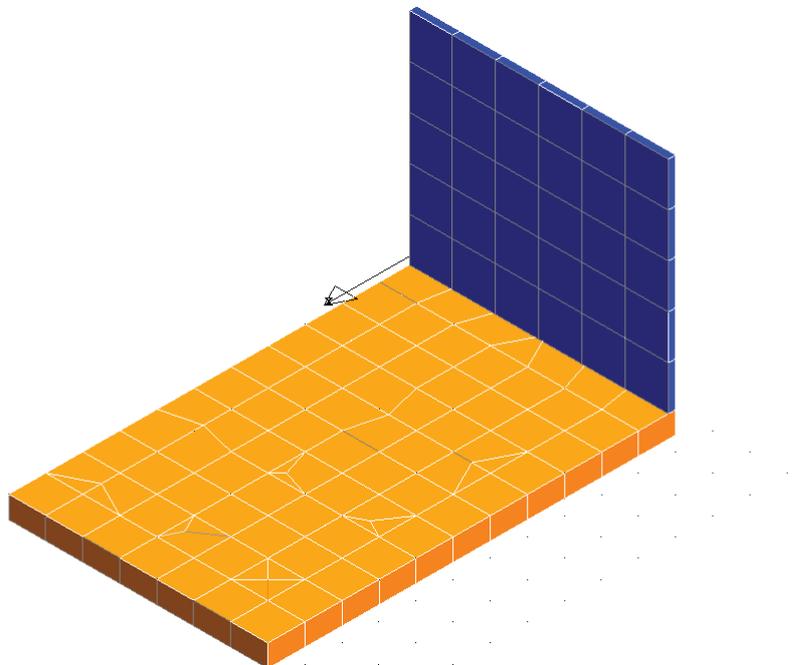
Rappresentazione tridimensionale della struttura (vista posteriore)
